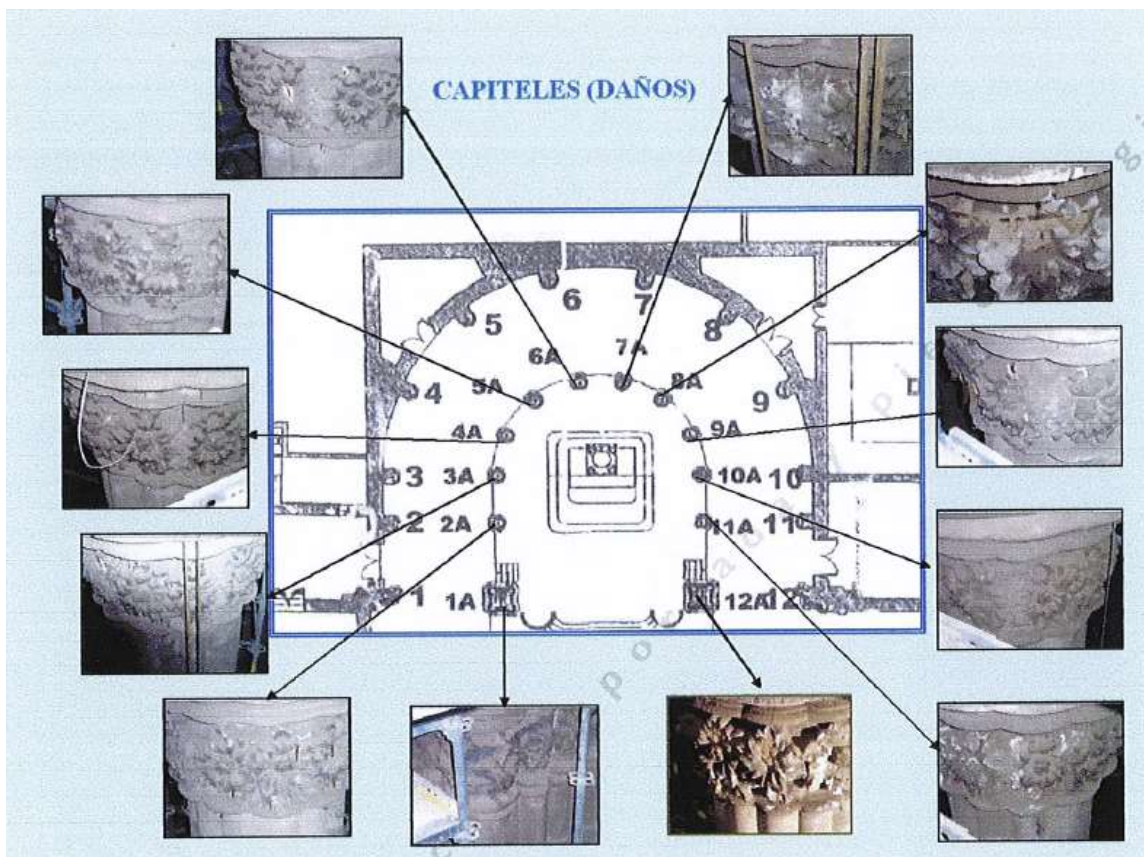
estado de conservación de los capiteles de las columnas de los cabeceros. Imagen del informe nº 18437 realizado por el IETcc para el Ministerio de Vivienda, Dirección general de Arquitectura
